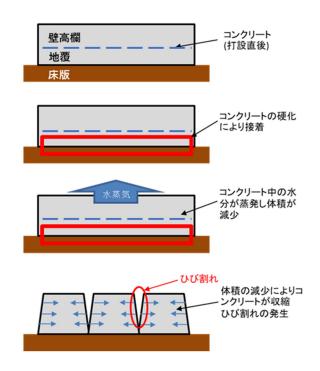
コンクリートにひび割れが生じるメカニズム
